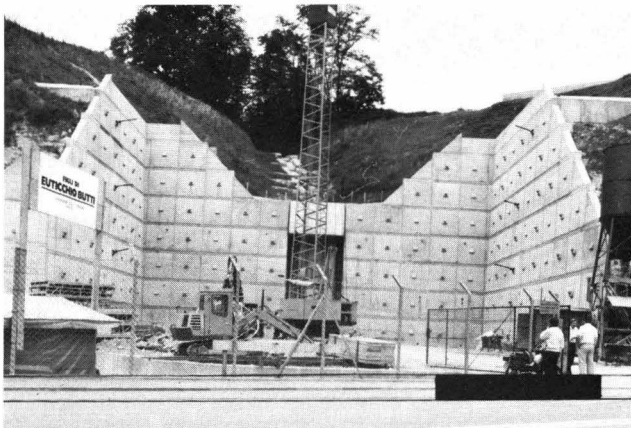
Bauzustand mit vertikaler Drainage. Vorbohren der Löcher für vertikale Anschlussarmierung – Phase d'exécution avec drainage vertical. Percage des trous pour le treillis de raccordement – Construction stage with vertical drainage. Drilling the holes for the connecting steel mesh
